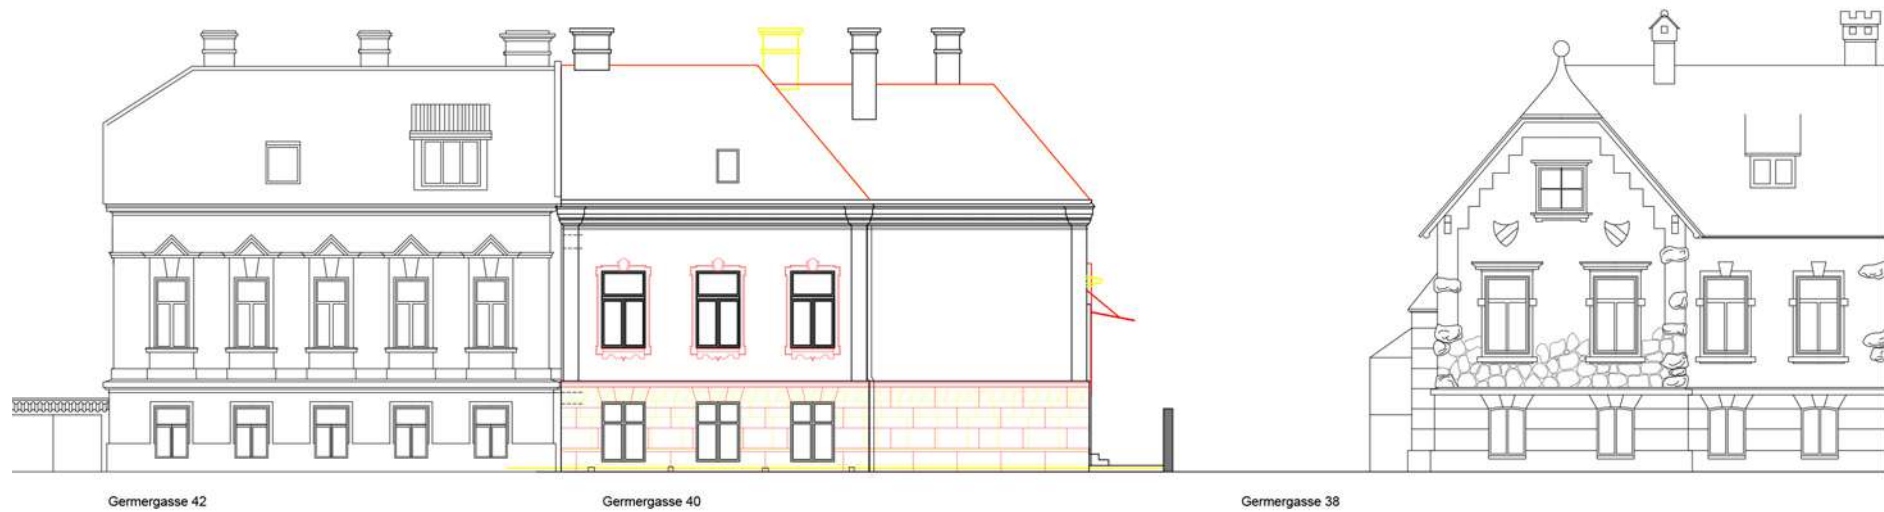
Ansicht Straßenfassade Umbau, M=1:200.
